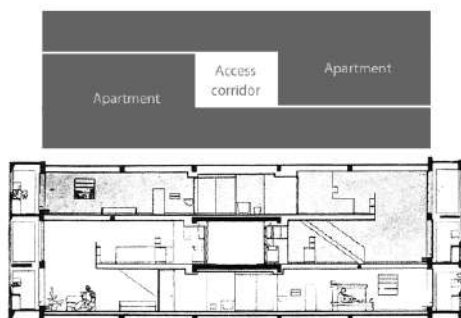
Corte transversal do pavimento tipo da *Unité D'habitation de Marselha*.
